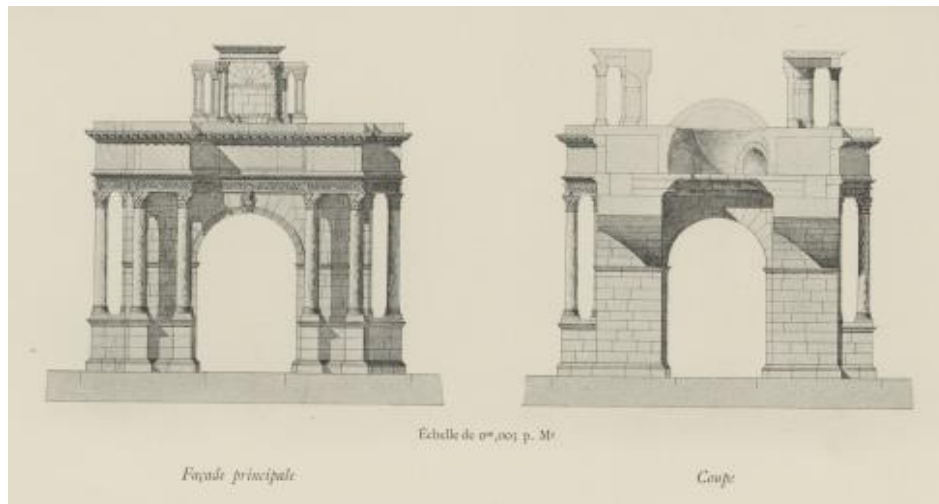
Façade et coupe de la Restitution de la porte de Caracalla proposée par Ballu
